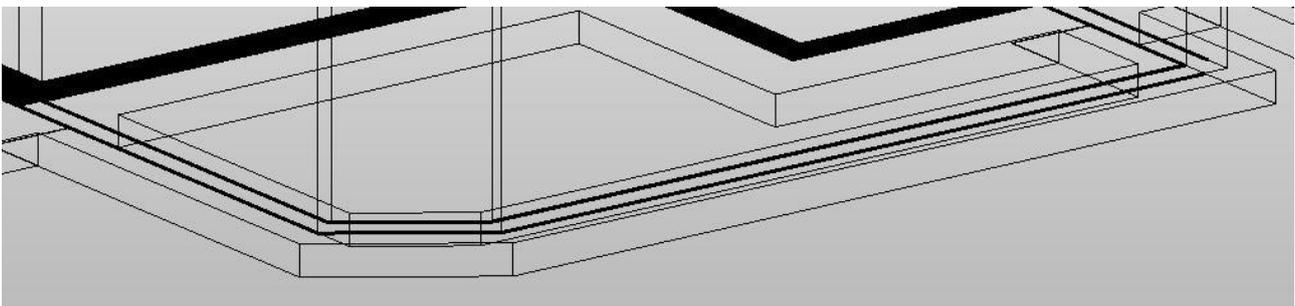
Streifenfundamente – Streifenfundamente an einer 25cm breiten Stahlbetonwand
